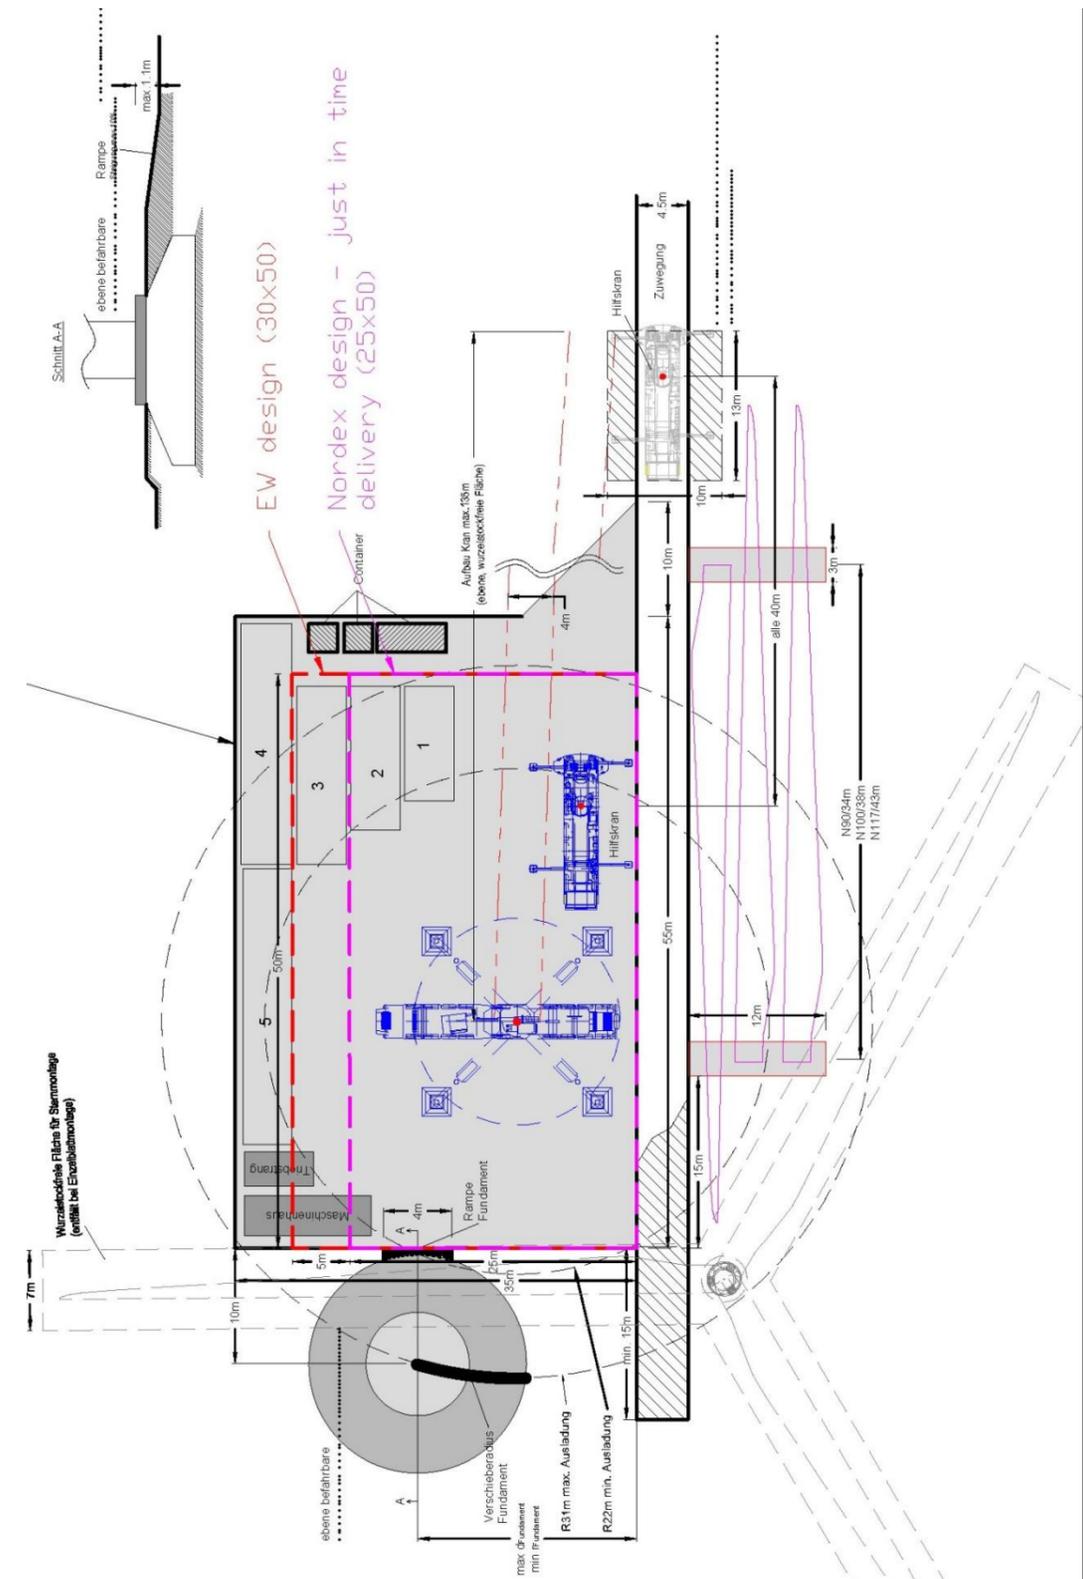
Exemple d'aire de montage (Source : NORDEX)
